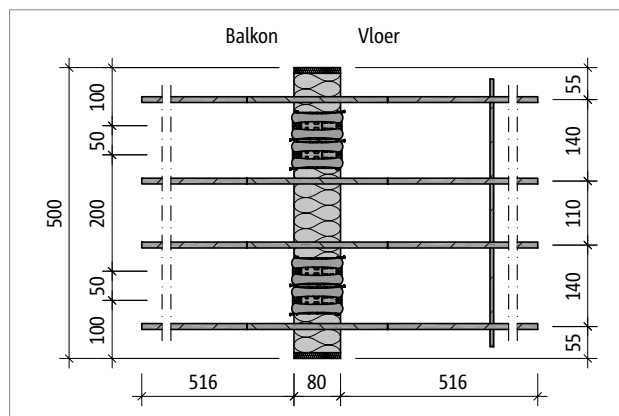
Schöck Isokorf® T type Q-E-W-V5: Bovenaanzicht
